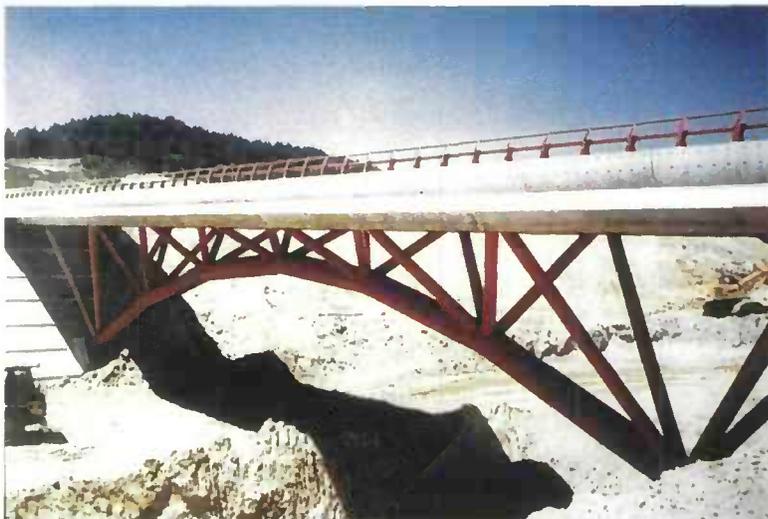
Un ouvrage manifestement non courant : L'ouvrage d'Antrenas sur l'autoroute A75
